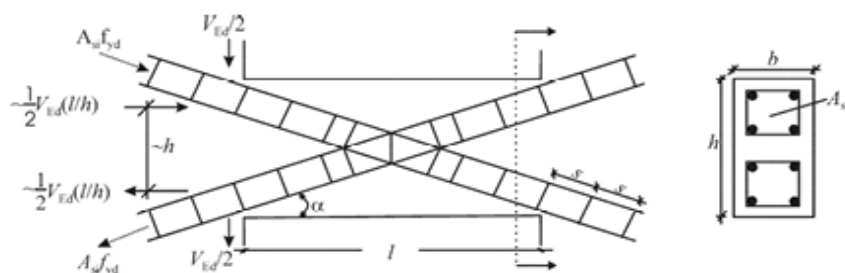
Armaduras diagonais na viga de acoplamento[6]
